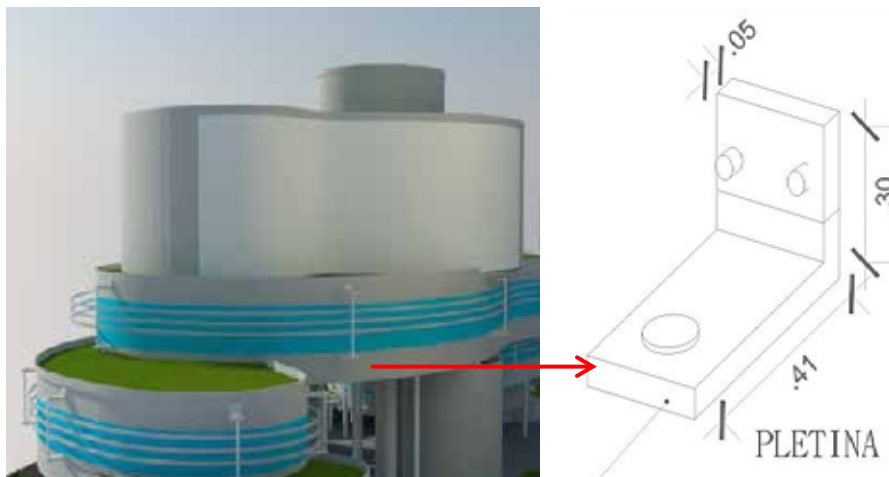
Detalle pletina de aluminio, rejilla metálica.
